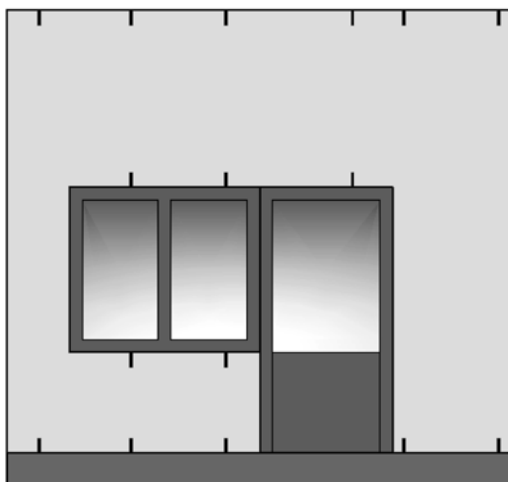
Приклад розташування вентиляційних пристроїв на фасаді будівлі
